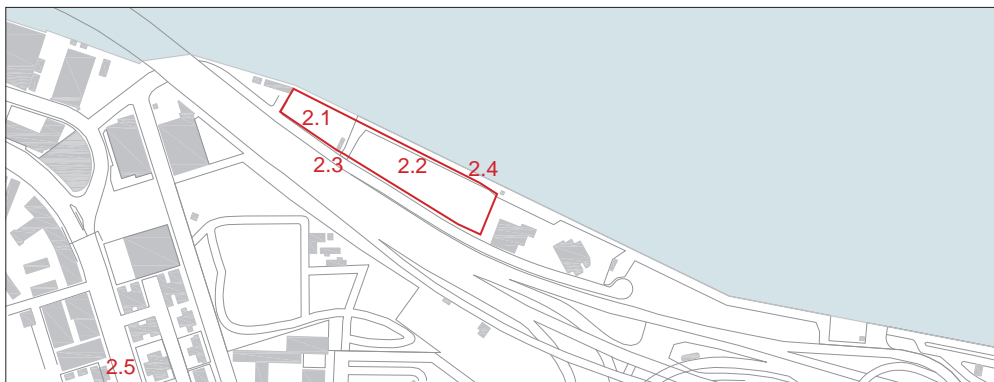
Lageplan - Grundstücksituierung im Bezirk Quarry Bay
